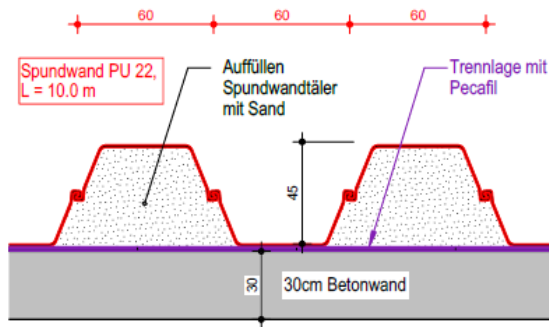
Aufbau Betonwand – Trennlage - Spundwand
